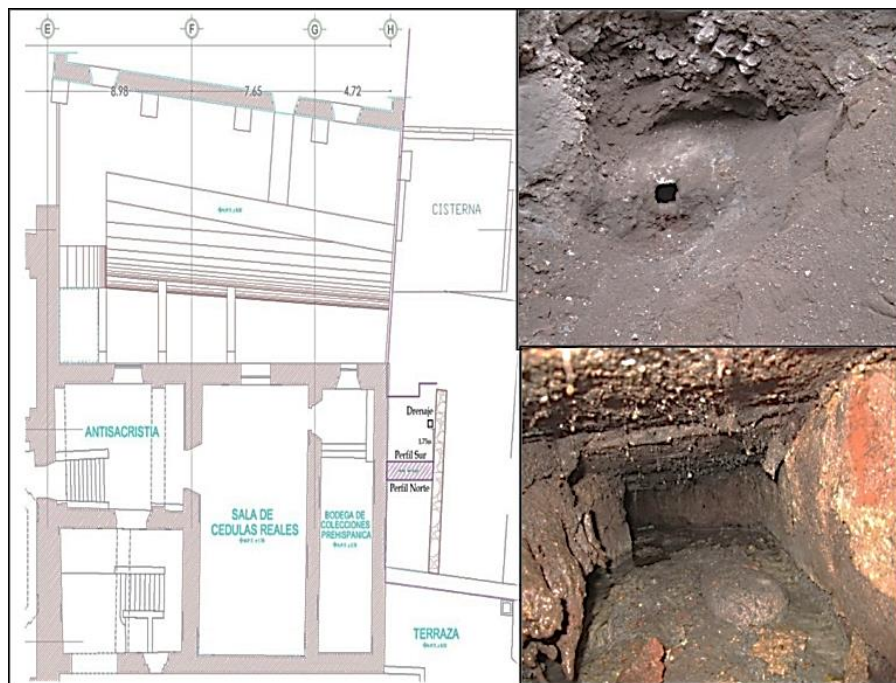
Ubicación del drenaje, vista exterior e interior⁵⁸⁹
